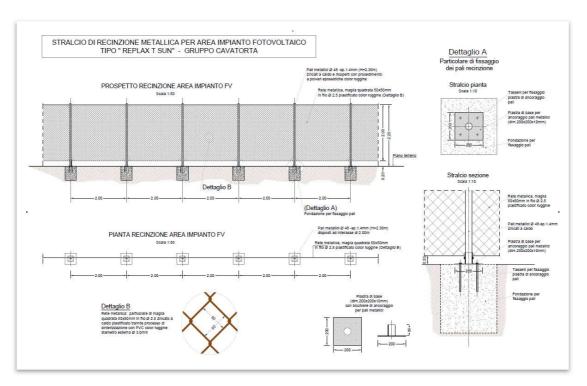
Pianta e sezioni delle opere di recinsione dell'impianto
